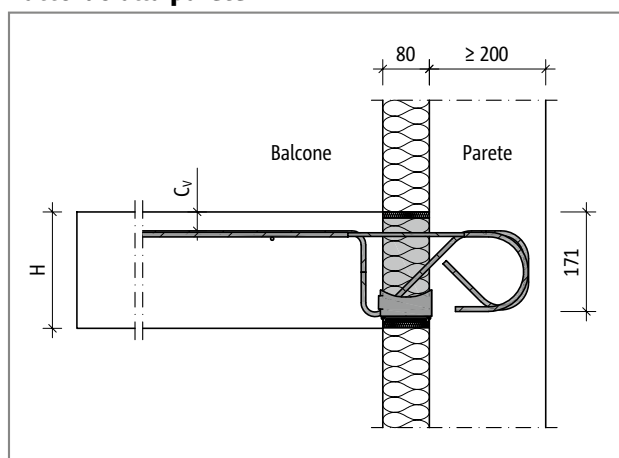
Schöck Isokorb® T tipo KL-O-M1 - KL-O-M7: raccordo alla parete con isolamento esterno
